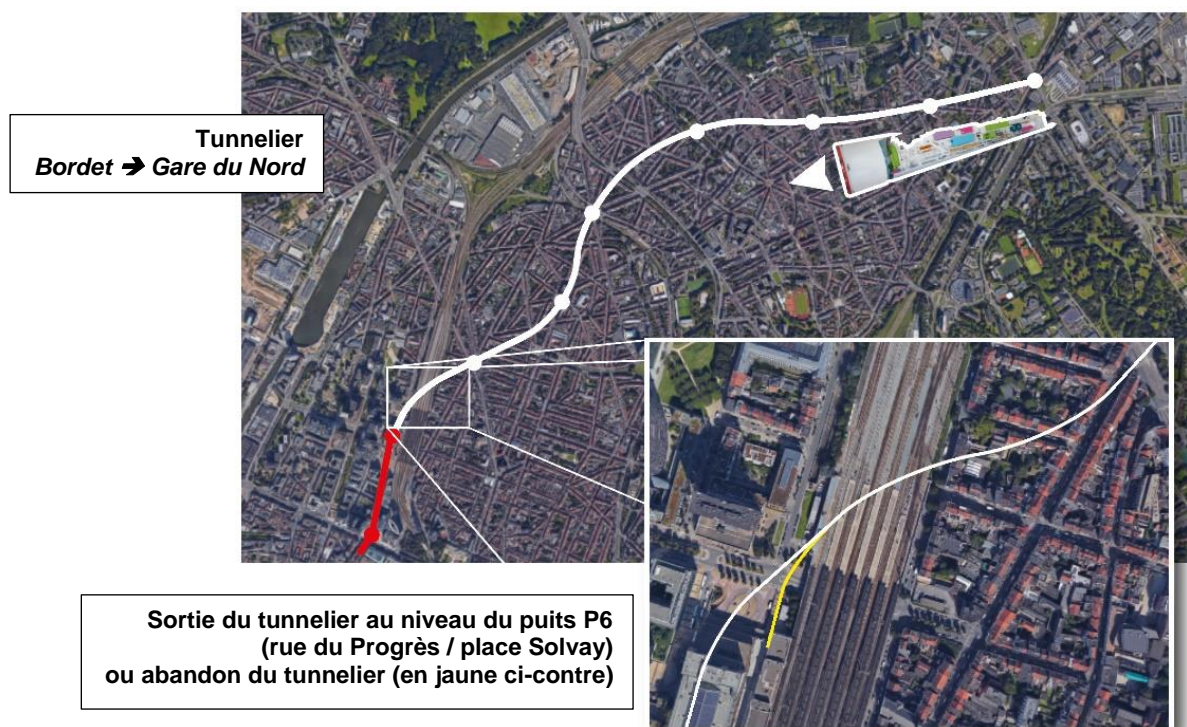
Utilisation du tunnelier entre Bordet et la Gare du Nord (source du fond de plan : <https://www.google.com>)
